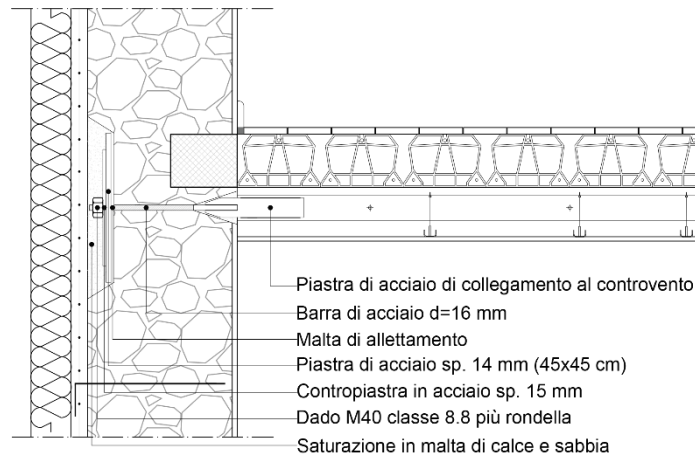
Dettaglio in sezione degli interventi di consolidamento mediante controventi in acciaio su solai e collegamento mediante catene alle pareti perimetrali.
